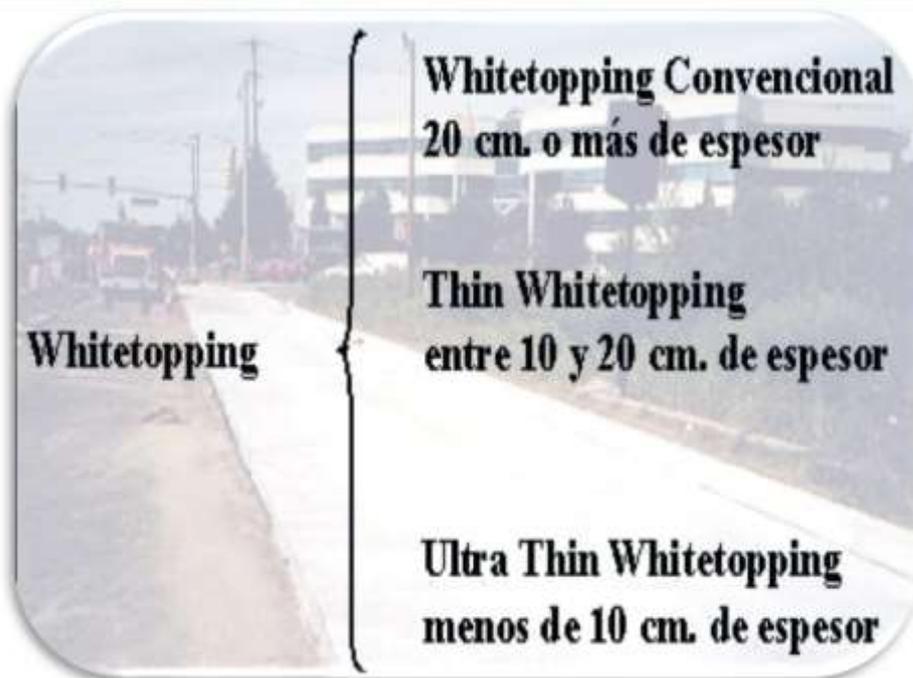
Clasificación de los pavimentos de hormigón sobre asfalto, según su espesor.
